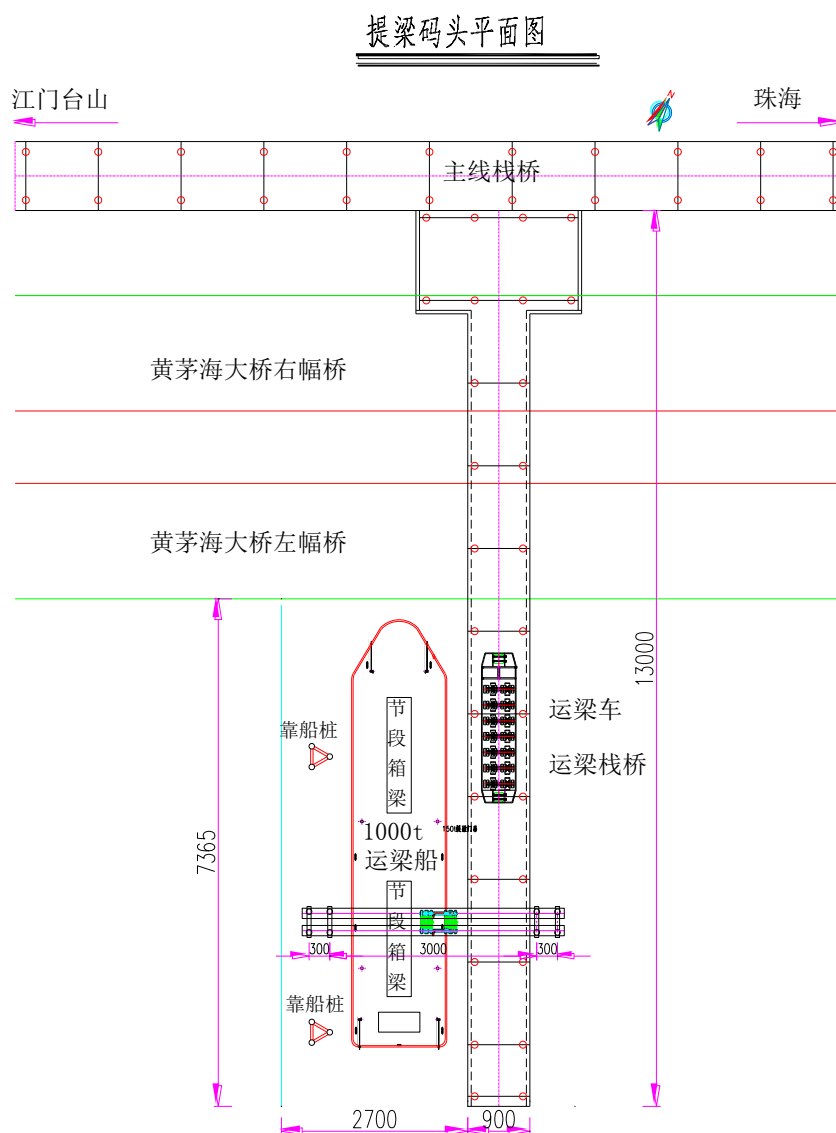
提梁码头平面图（单位尺寸：cm）
